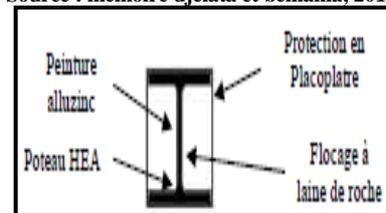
Détail n°02: poteau HEA 300 (1/20)
